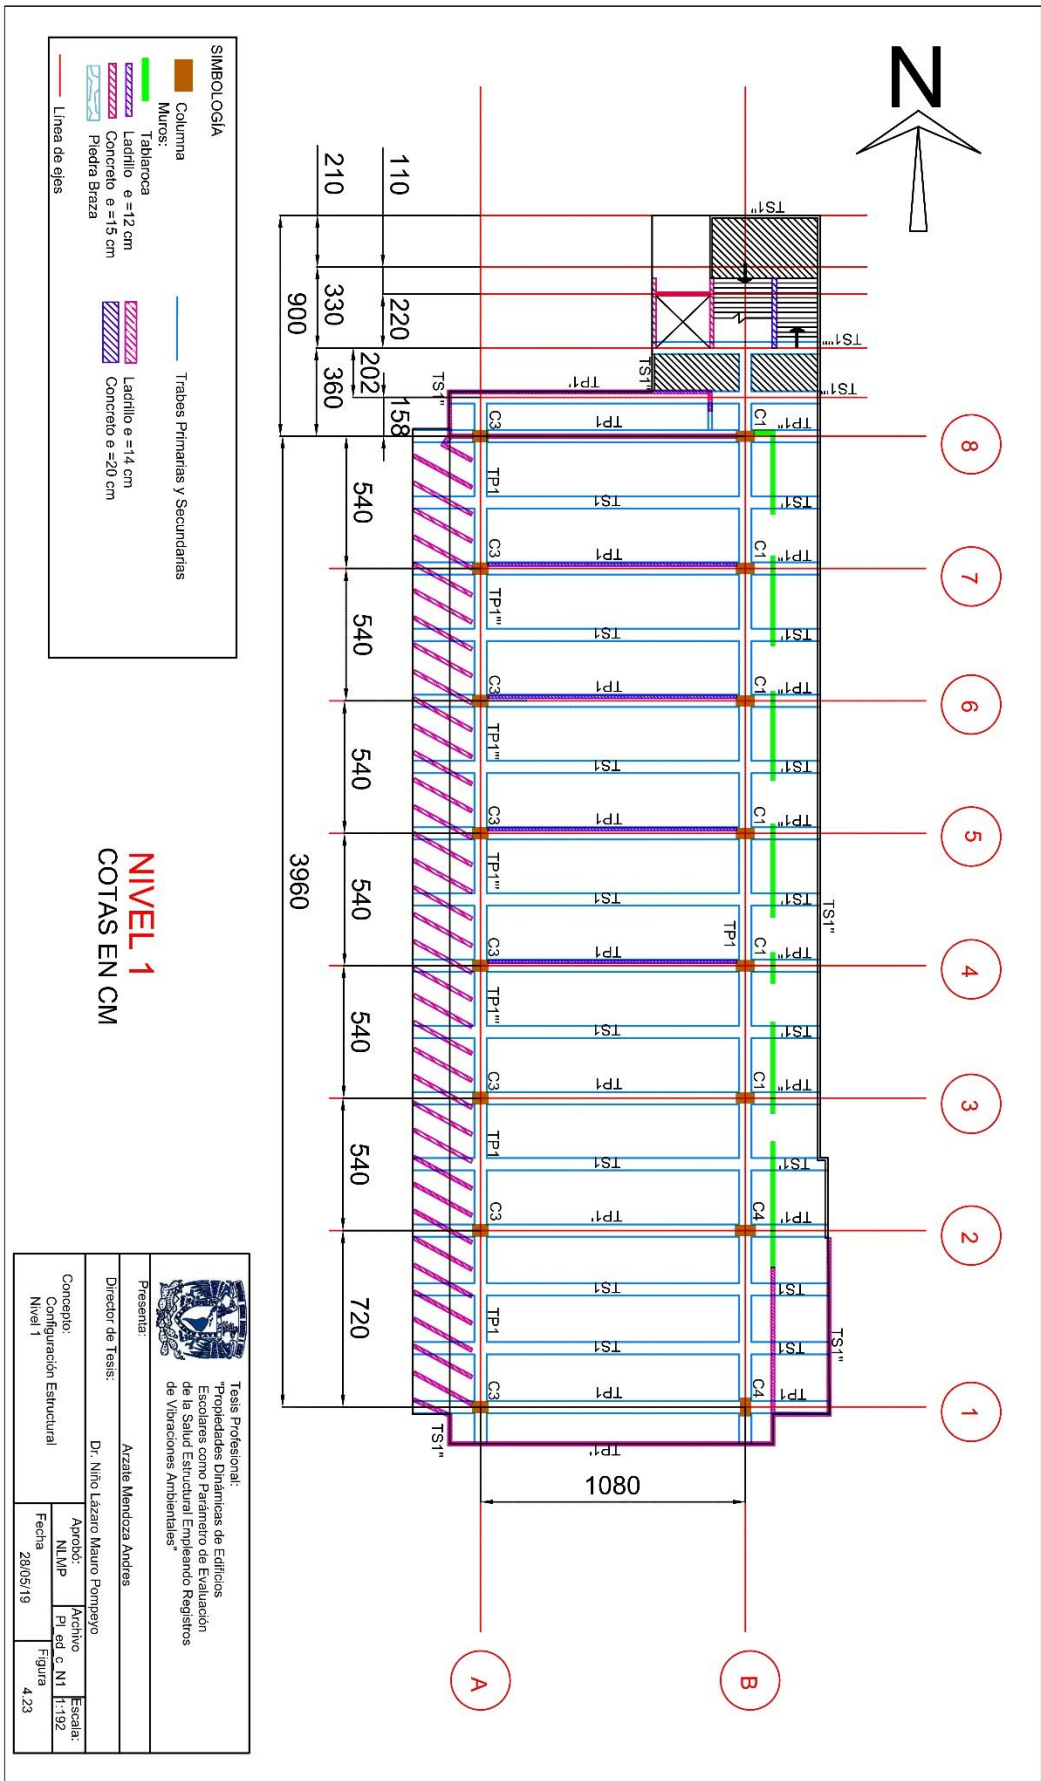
Planta estructural nivel 1 edificio C FI, UNAM
